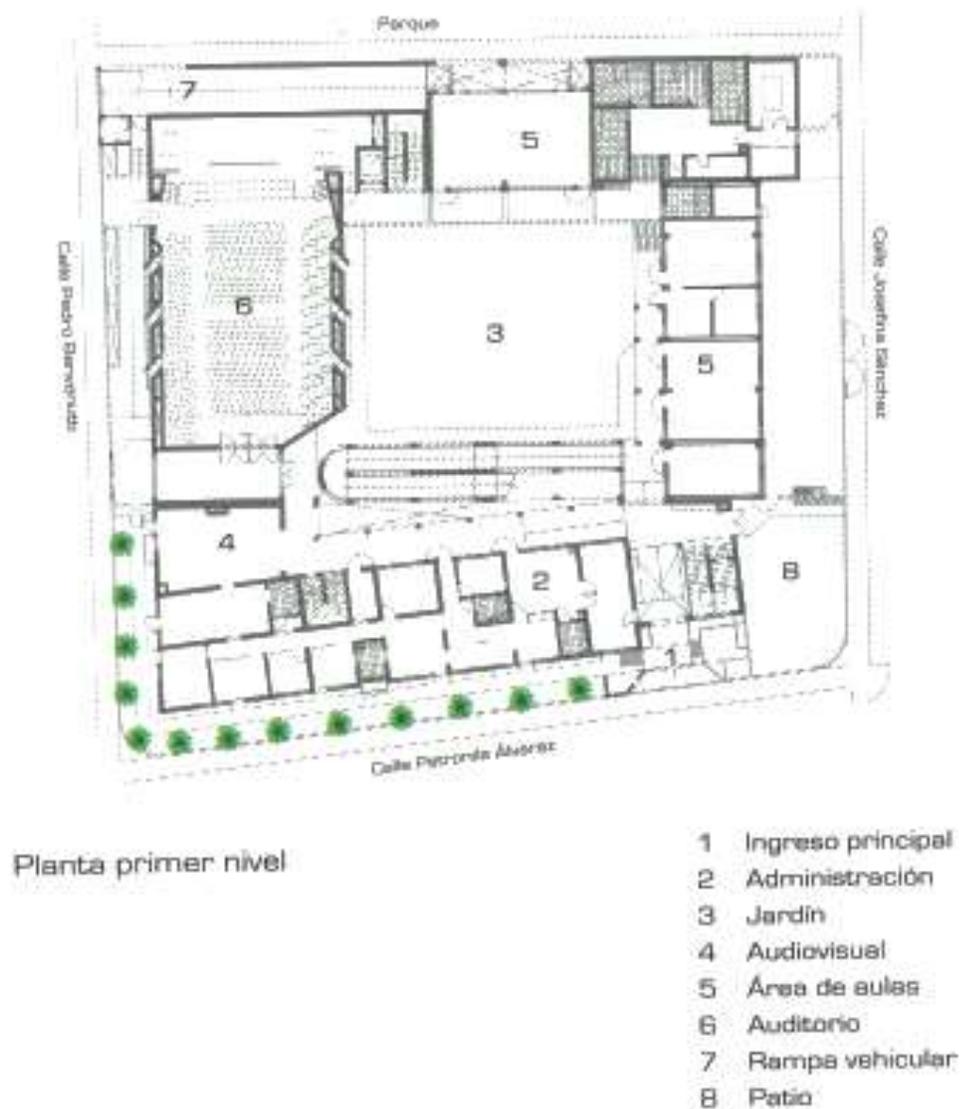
Planta del Primer Nivel. Fuente: José Bentín Arquitectos.
